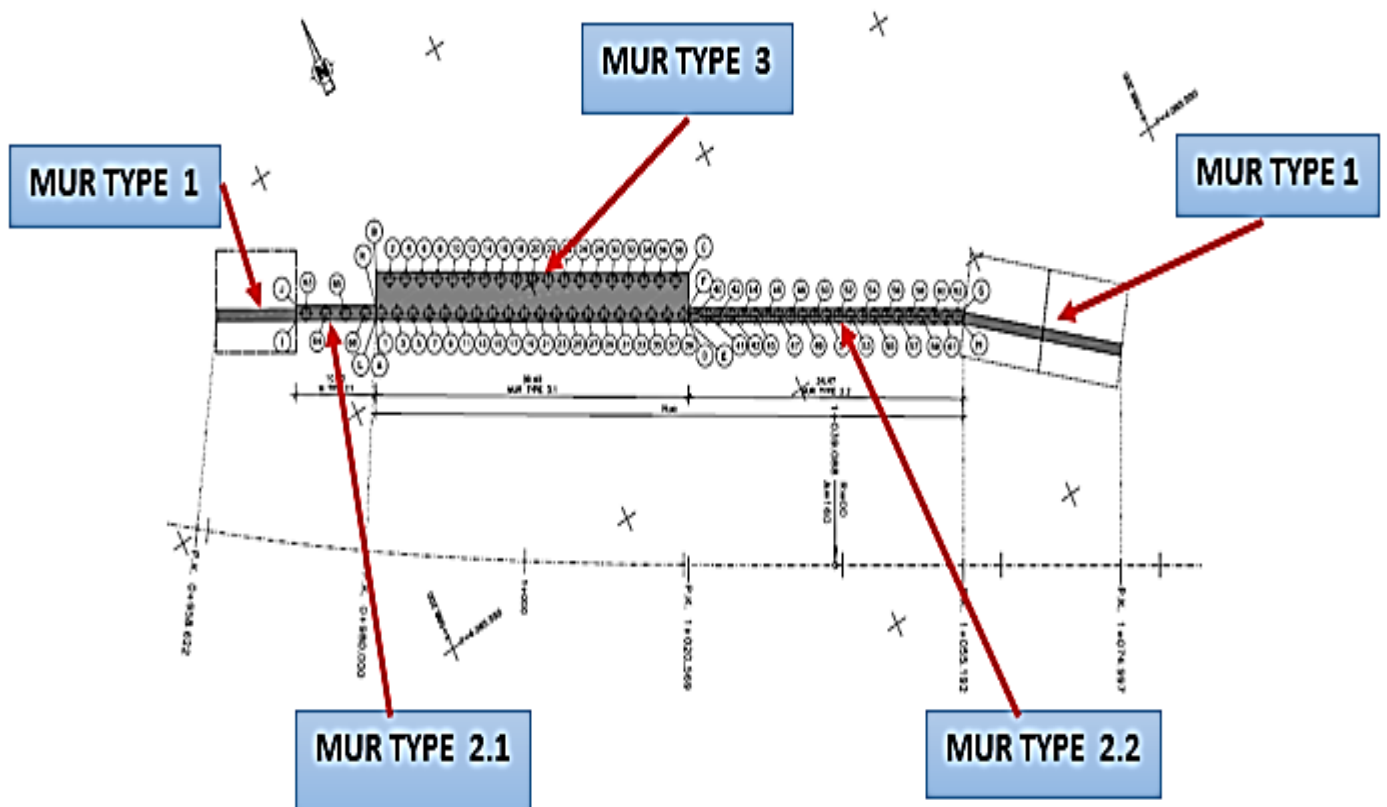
Vue en plan de mur pieux échelle 1 :250.
